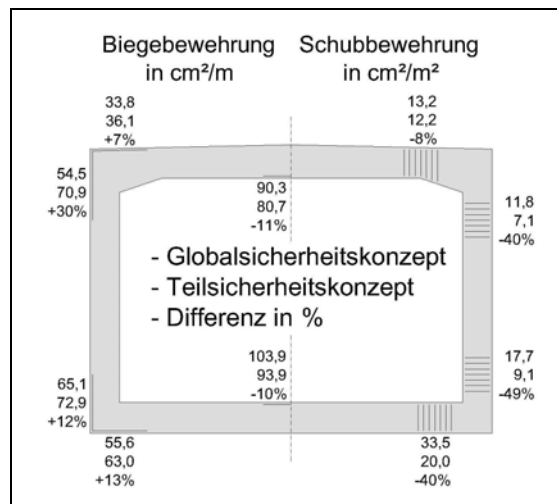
Tunnel in offener Bauweise, Bewehrung aus Nachweisen im Grenzzustand 1 B, Teilsicherheitskonzept mit LF Brand
